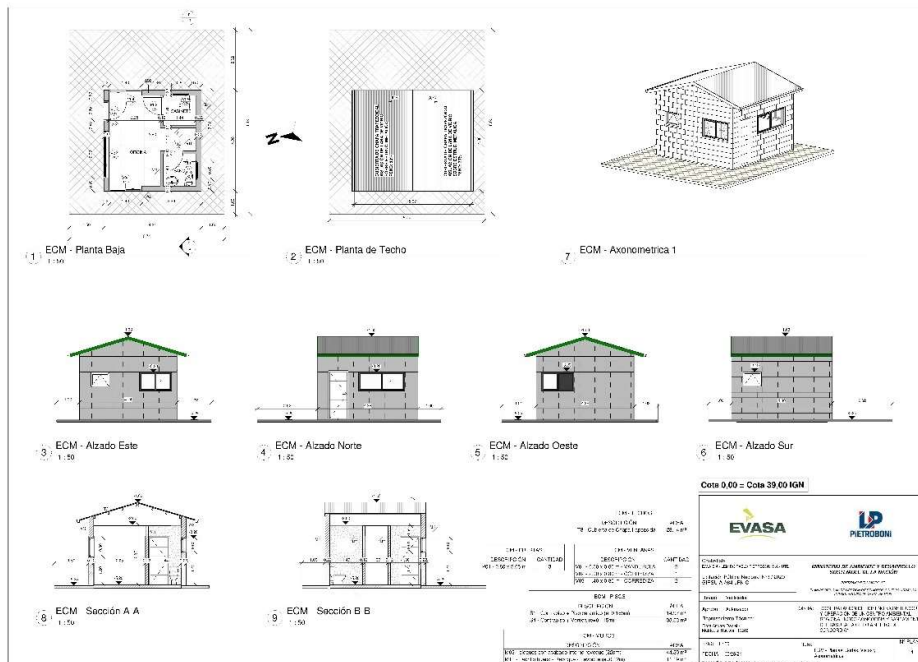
Edificio Balanzas. Plantas y Cortes.
